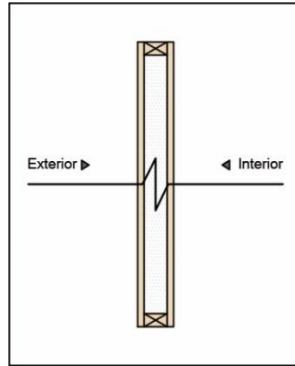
Sección esquemática sistema de aislamiento dentro del muro, elaboración propia.
